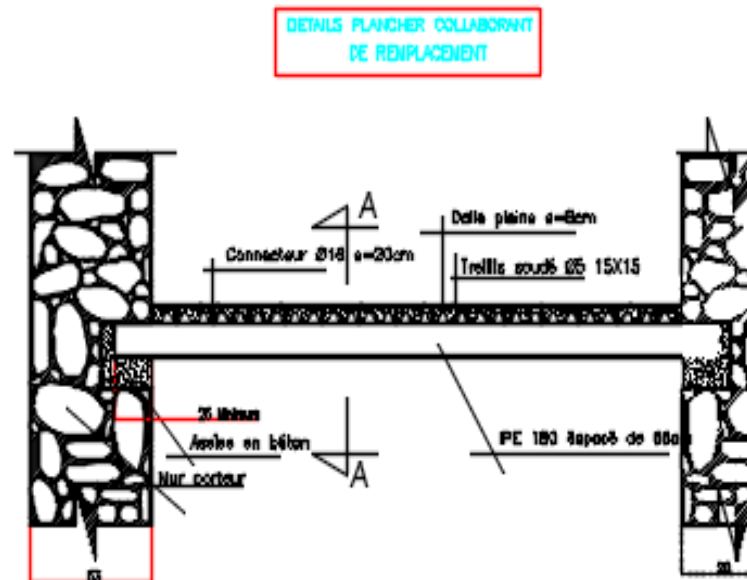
CONFORTEMENT D'UN PLANCHER
